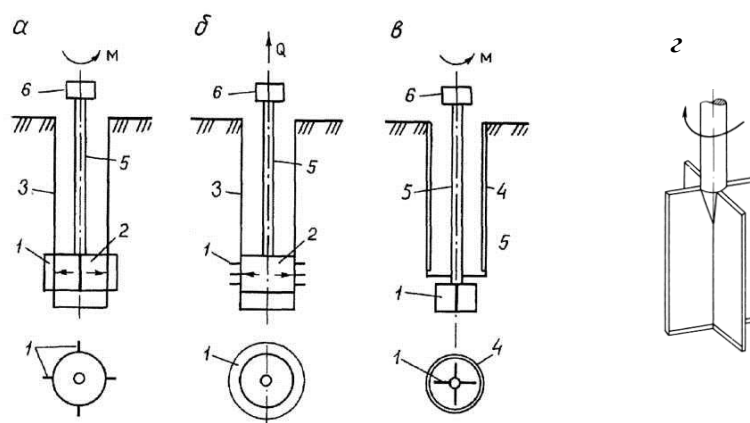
Схемы испытания грунта в скважинах на срез:
